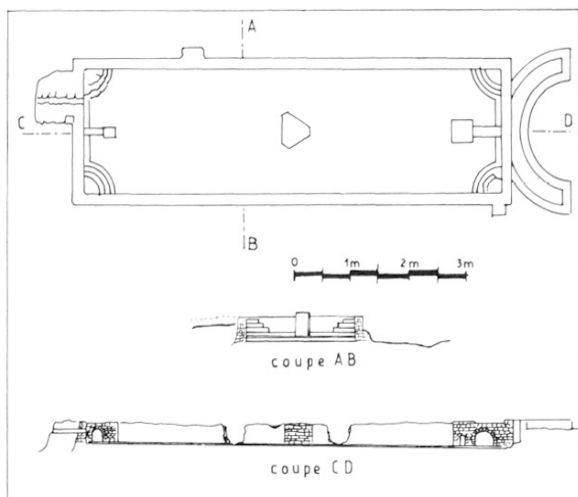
Les « Bains de la Reine » d'après le plan de De Villiers du Terrage.
